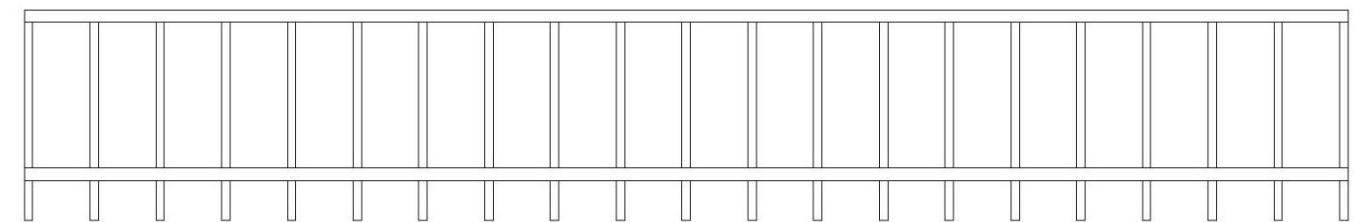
Entramado del puente doble arco atirantado de tablero inferior
